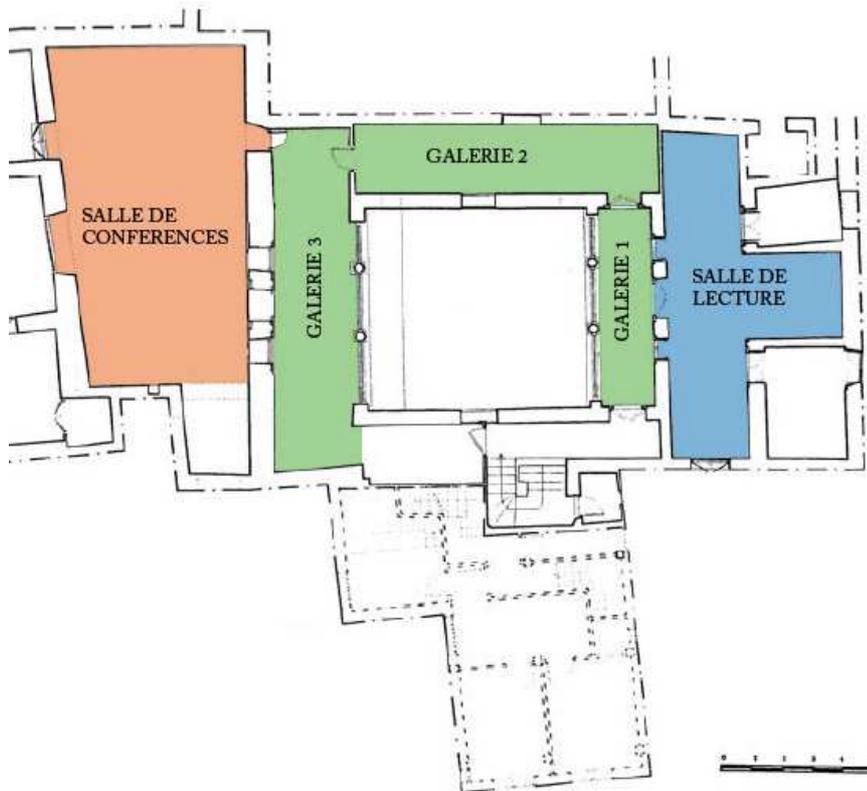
Plan Etage Dar Ben Achour avec mention des espaces étudiés
